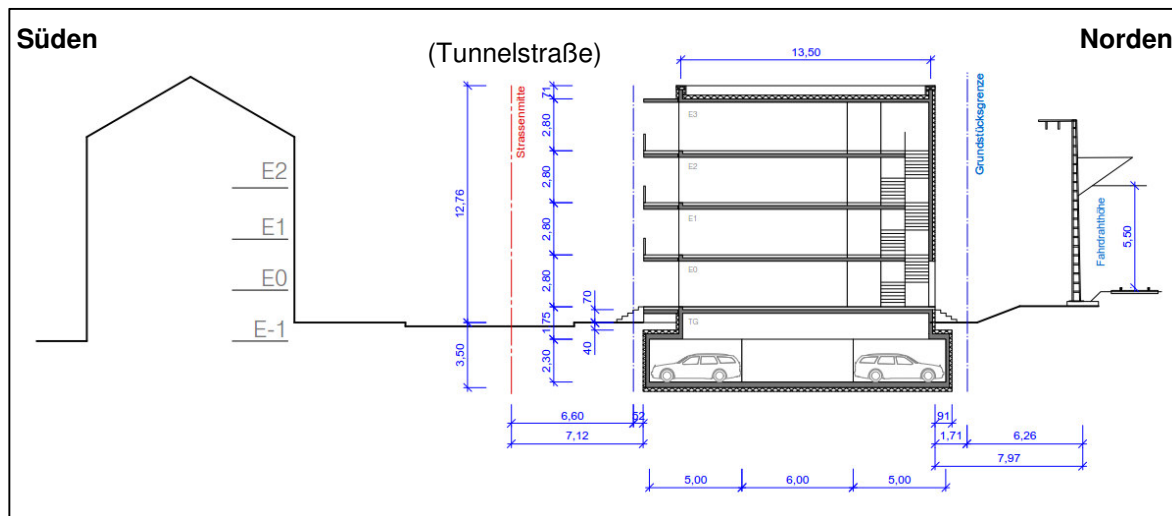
Nord-Süd-Schnitt geplante Bebauung, Stand: 07/2014
